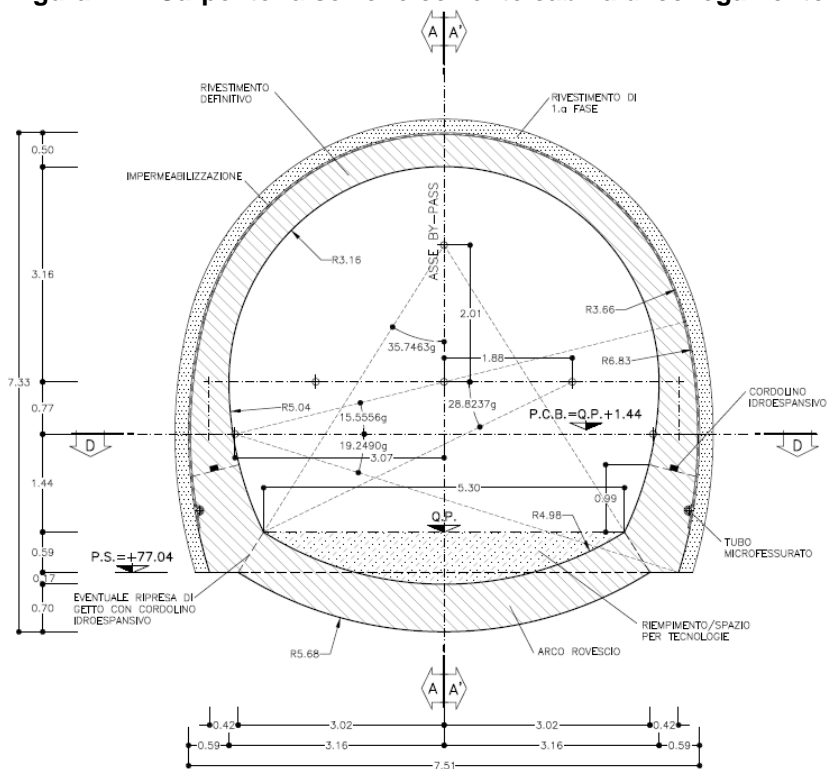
Carpenteria sezione corrente by-pass di collegamento
